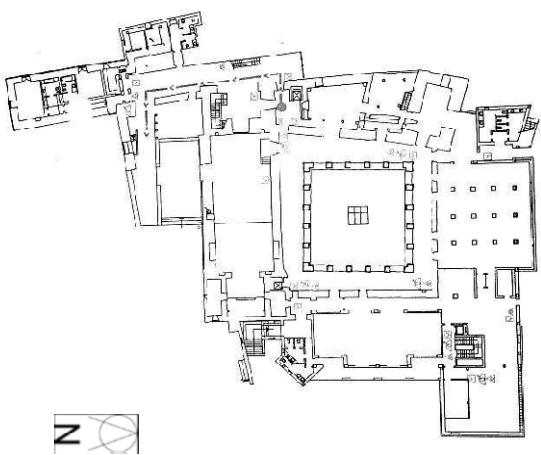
Planta do piso 0 da Pousada D. Afonso II.
